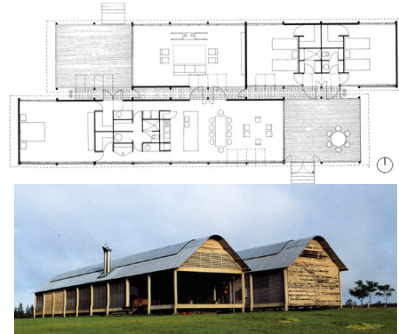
Casa Marie Short (1980).Planta y fotografía exterior.
